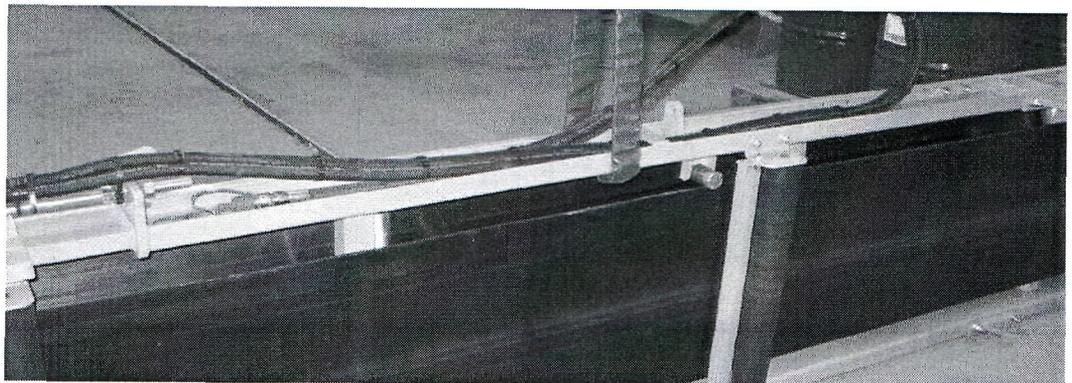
Fissaggio supporto a U (spine di fissaggio)
